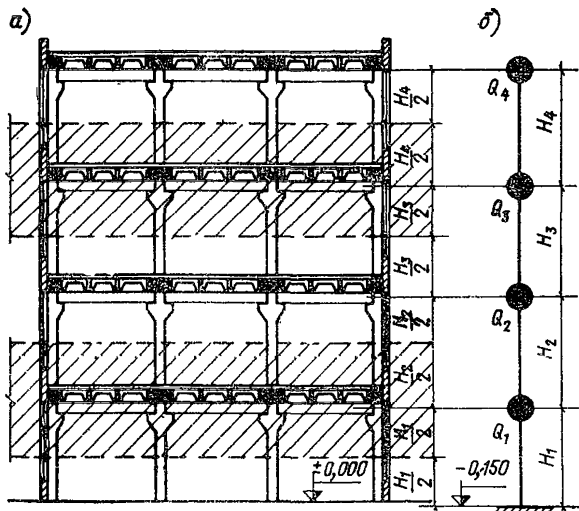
Динамическая расчетная схема каркаса многоэтажного здания
